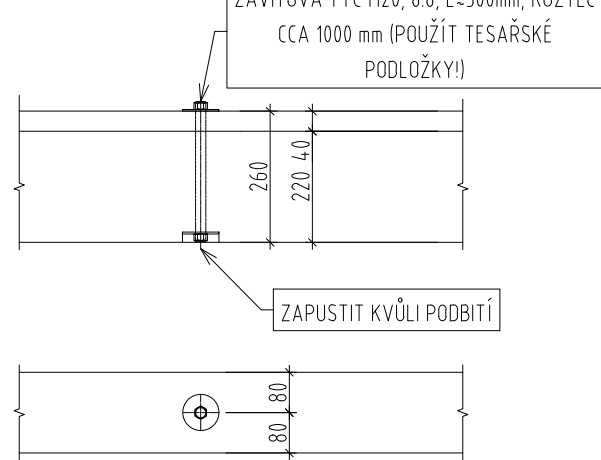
NAPOJENÍ ZAKLÁDACÍCH PRAHŮ
